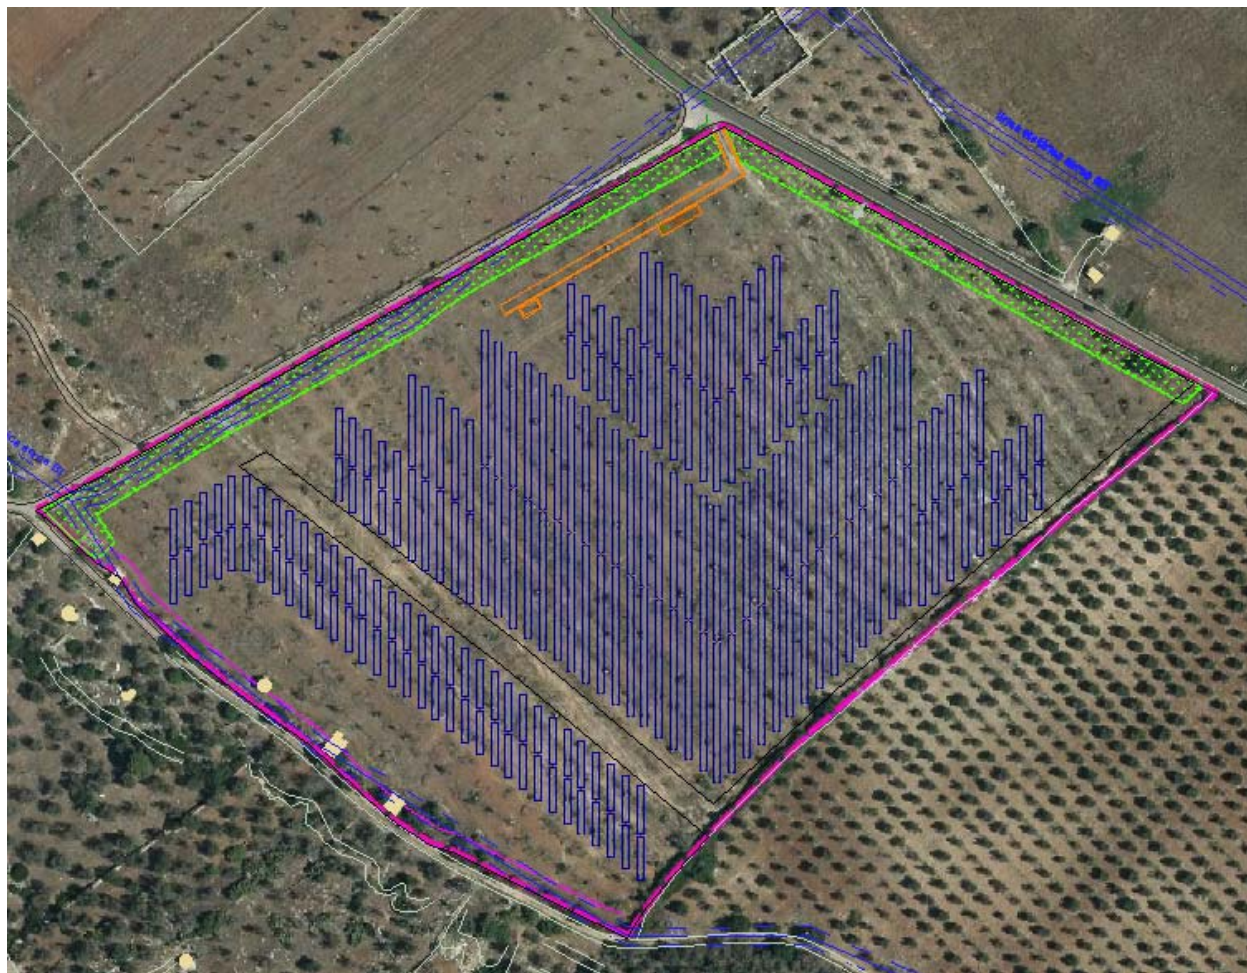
Layout impianto fotovoltaico in progetto lotto SUD
